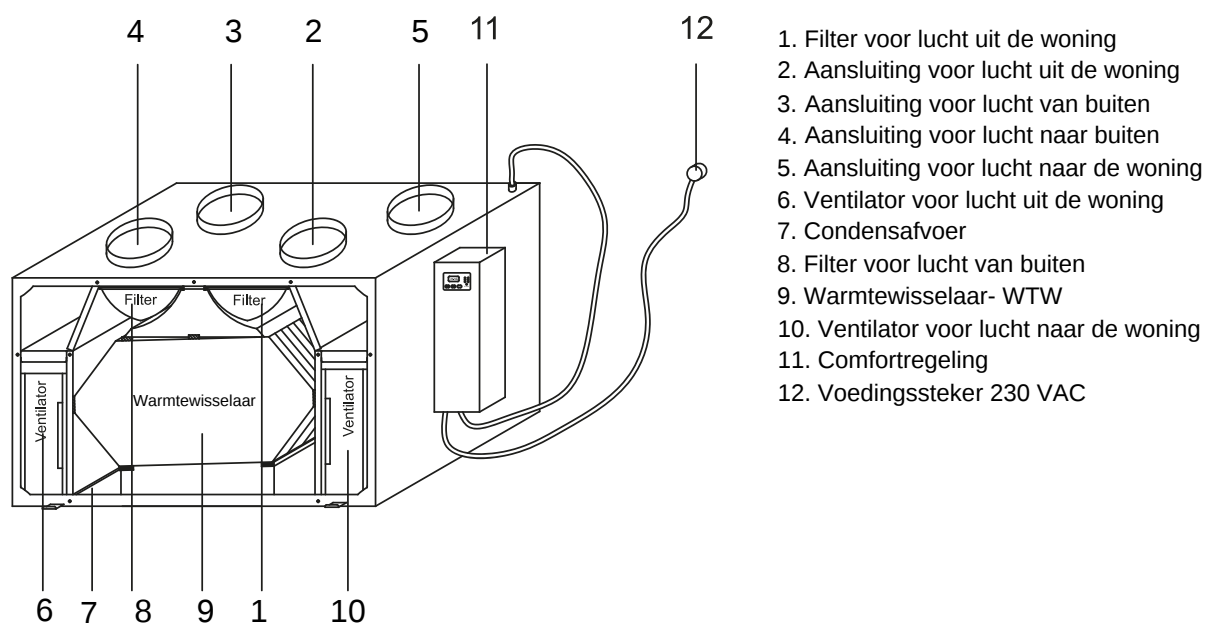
Voor- en bovenaanzicht EuroAir 400 (zonder bypass, rechtse uitvoering)
